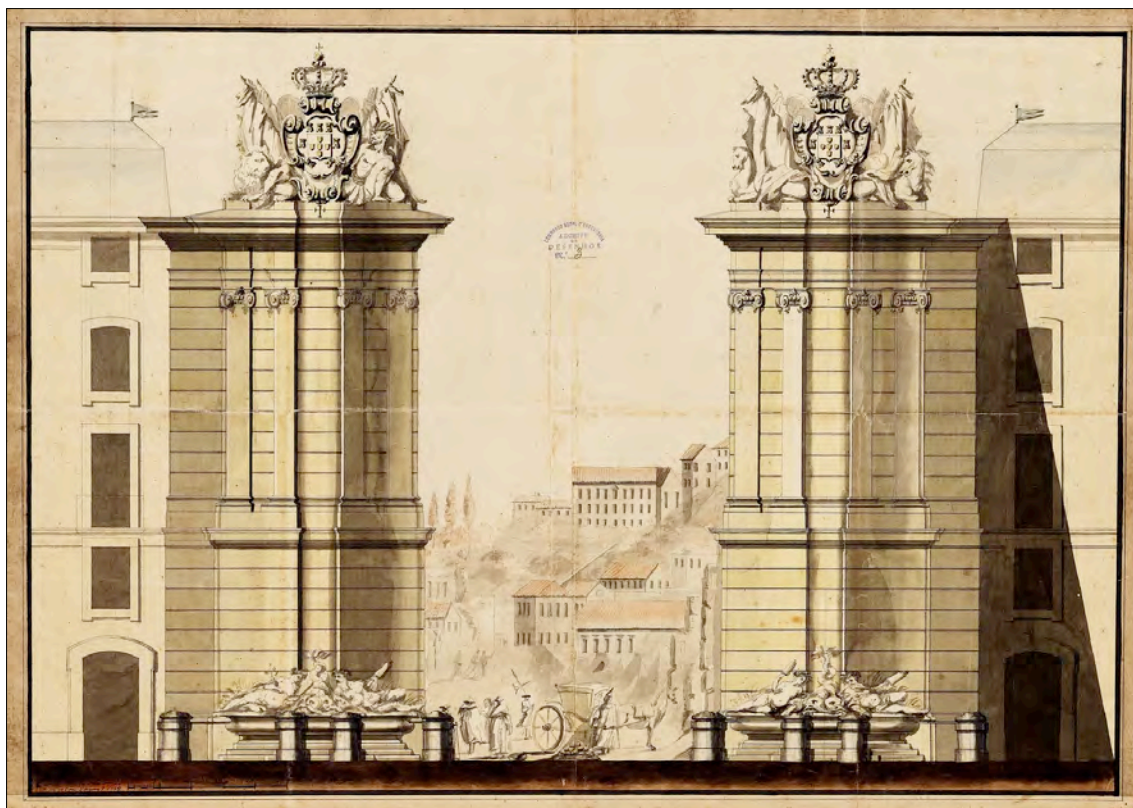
Prospetto - Progetto per l'accesso alla Rua Augusta da Praça do Comércio.
